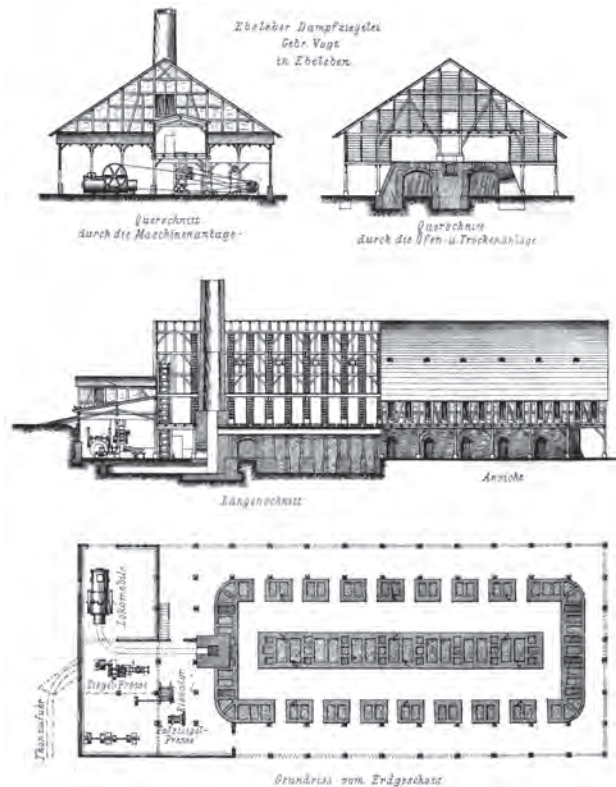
Dampfziegelei, gebaut um 1893 zur Herstellung von Vollziegeln, Formsteinen, Dränrohren und Falzziegeln, mit Großraumtrockner über dem Ringofen mit 16 Kammern. Produktionskapazität 2 Millionen Stück/Jahr.
